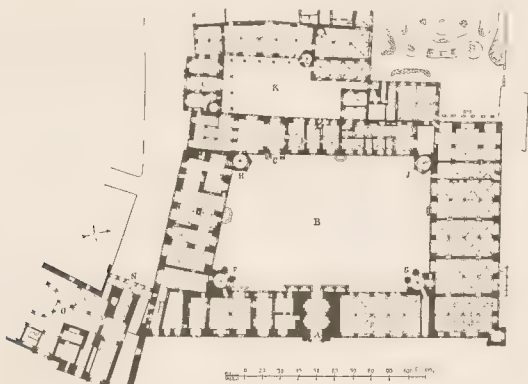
Grundriss des Koenigh. Schloesse. Nach Luebbe
